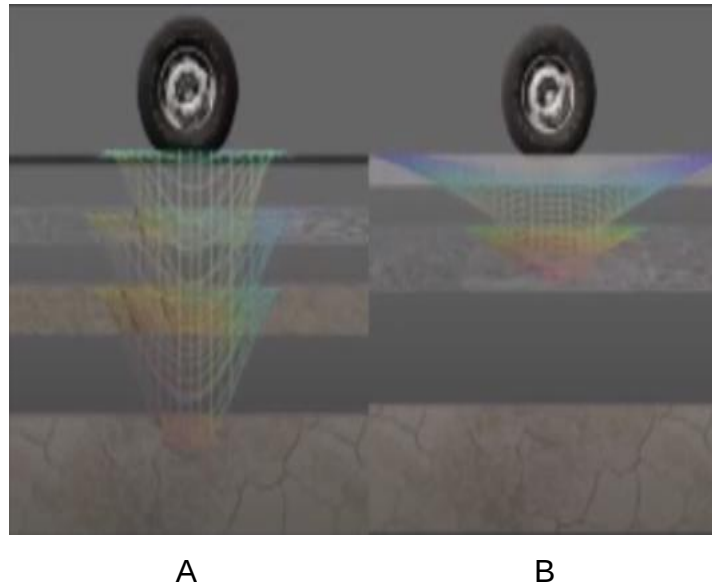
Distribución de Carga em Pavimentos Flexible (A) y Pavimento Rígido (B)
